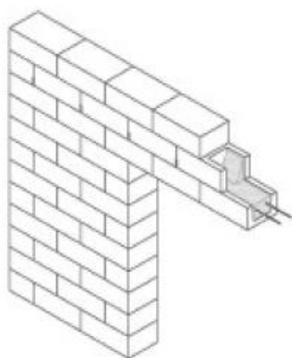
formazione dell'architrave di porta con blocco a canaletta riempito in calcestruzzo armato
